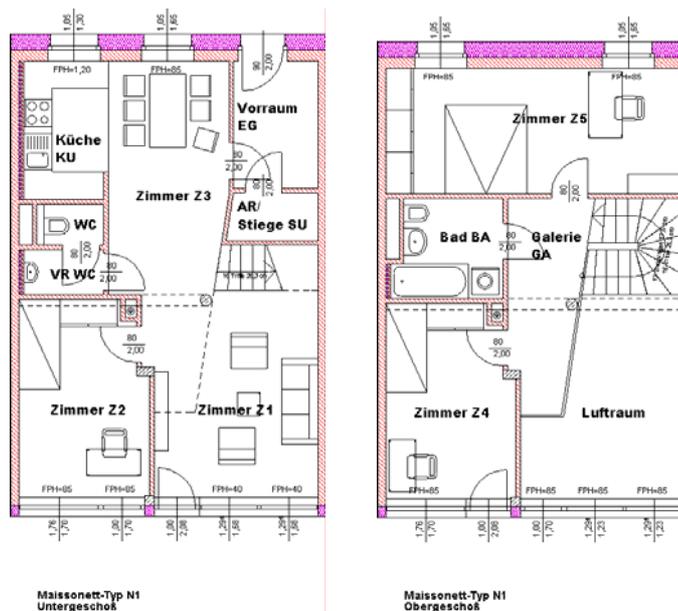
Grundriß des Maisonette-Typs N1 (Untergeschoss links, Obergeschoss rechts)
